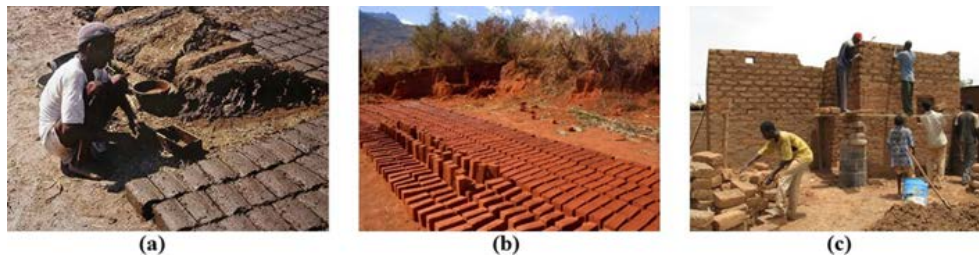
(a) : relative à la fabrication de la brique en terre crue (75% de terre, 20% de la paille et 5% d'eau). (b) : l'opération de séchage par l'exposition au soleil et (c) : construction d'une maison par la brique en terre crue. Source : archives l'auteur.
